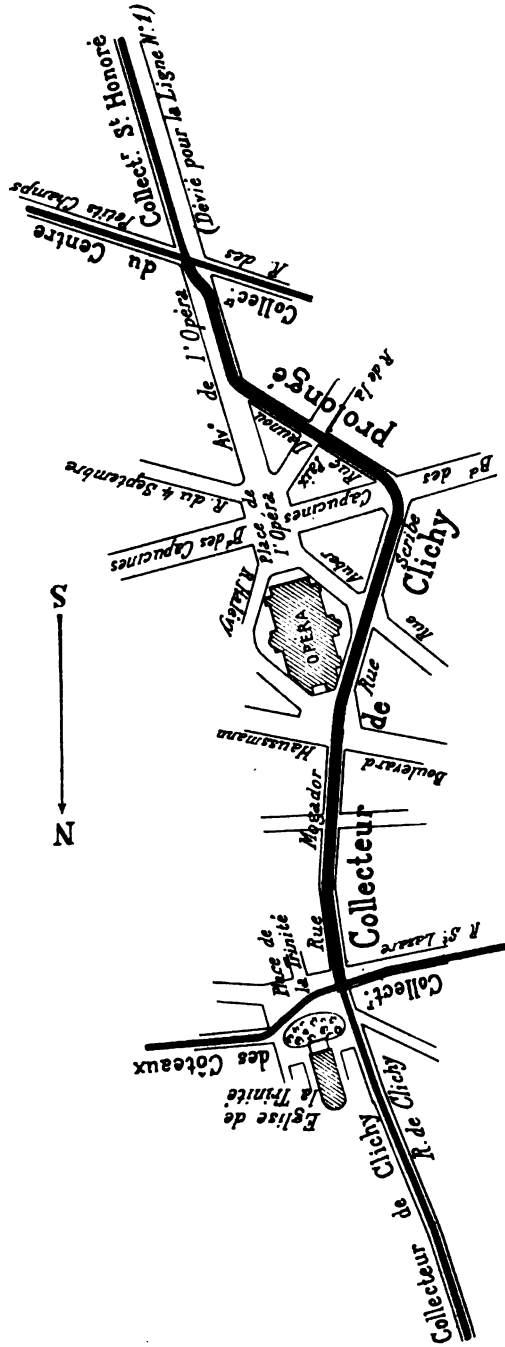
Prolongement du collecteur de Clichy. Plan général du tracé.
